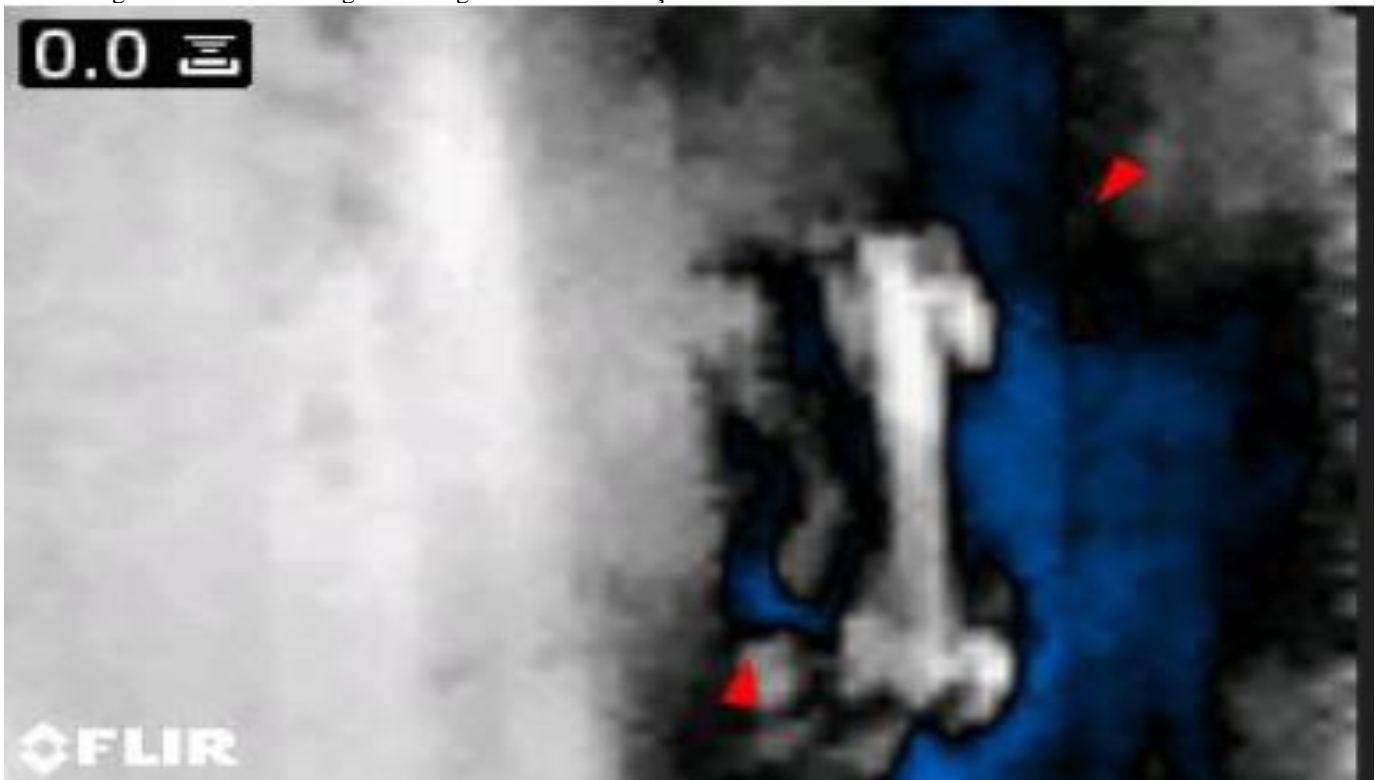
Vista da imagem termográfica com indicação de umidade – fachada do 3º andar
